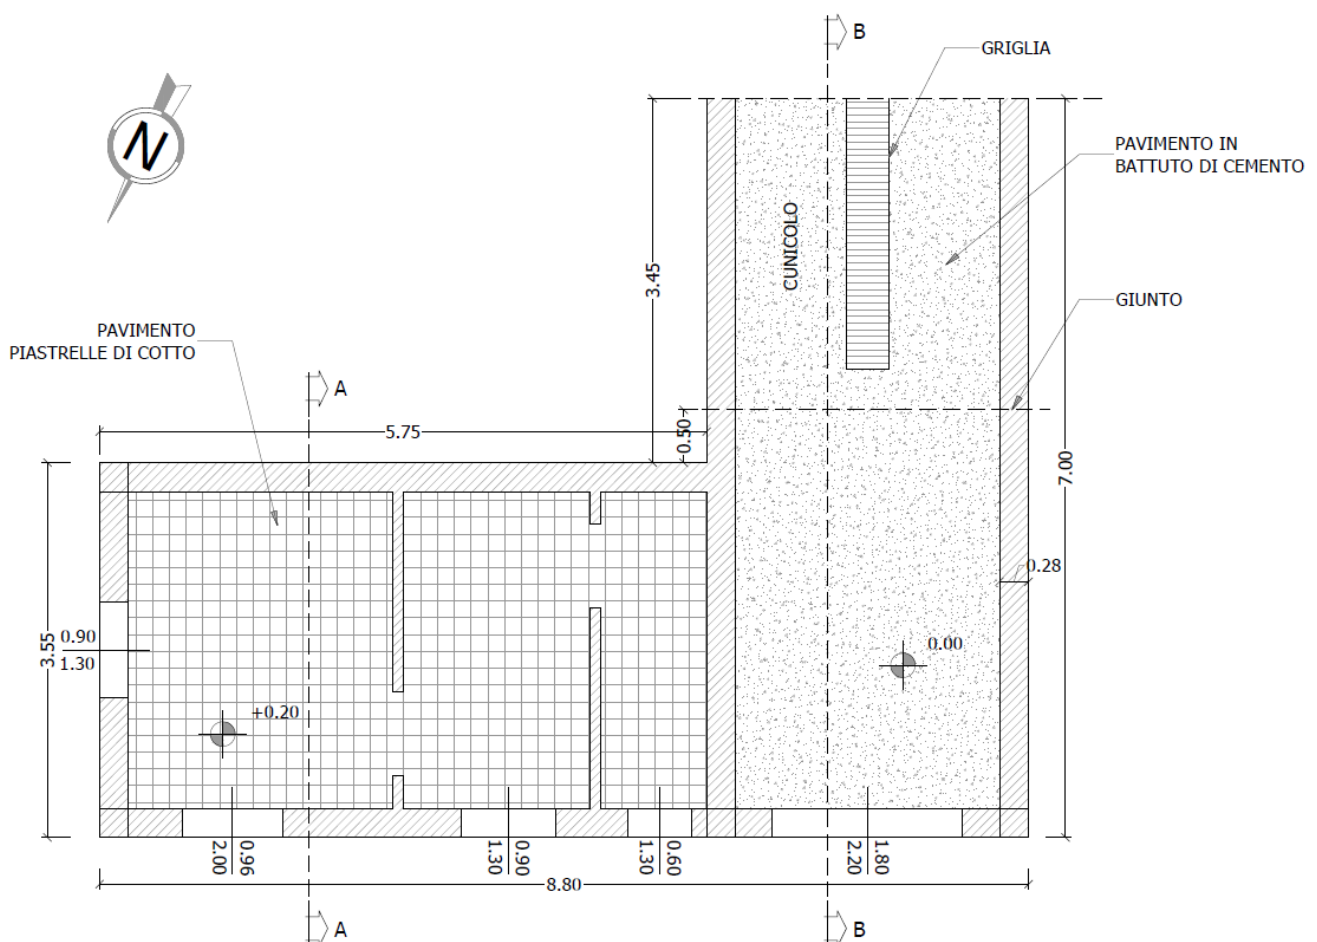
Pianta Edificio di Ricovero Guardiani
